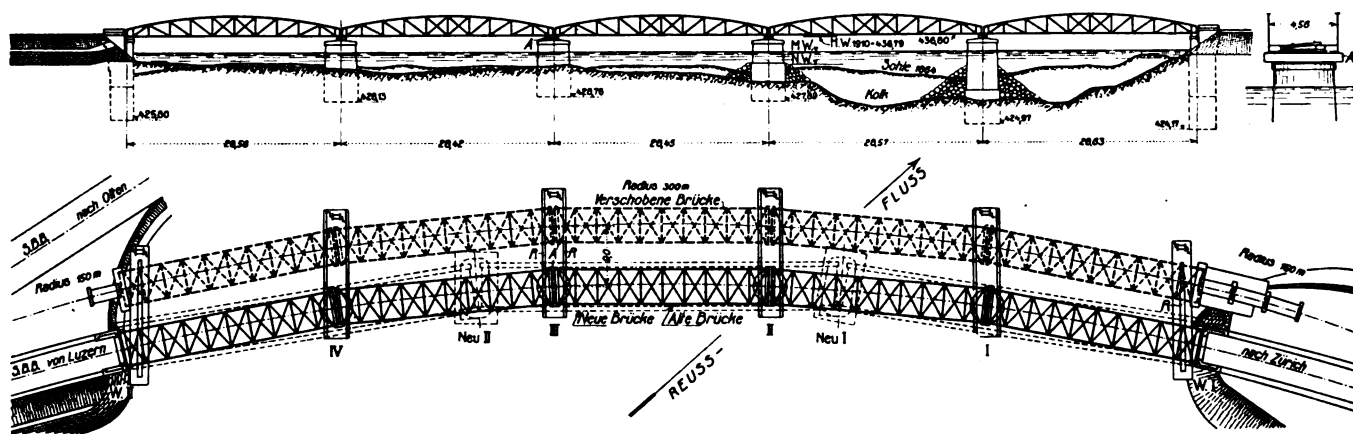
Ansicht, Querschnitt und Grundriss der alten Brücke, Grundriss der verschobenen und der neuen Brücke. — Masstab 1:1000.
